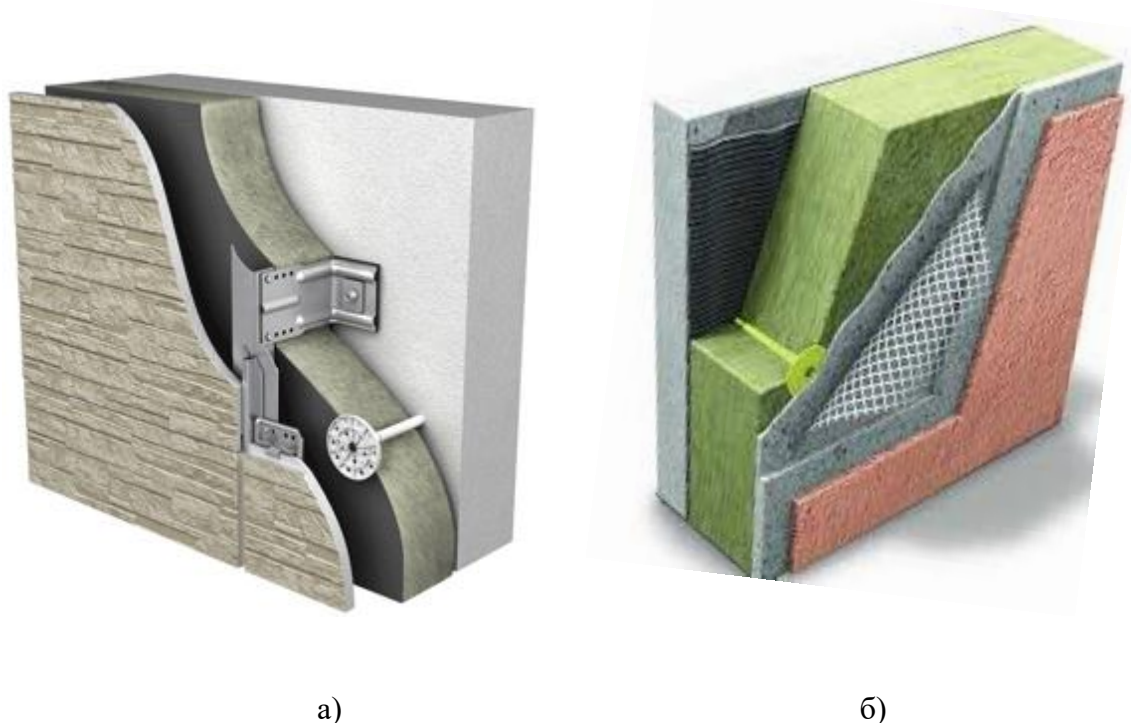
Современные методы утепления стен: а) вентилируемый фасад; б) - «мокрый» фасад
